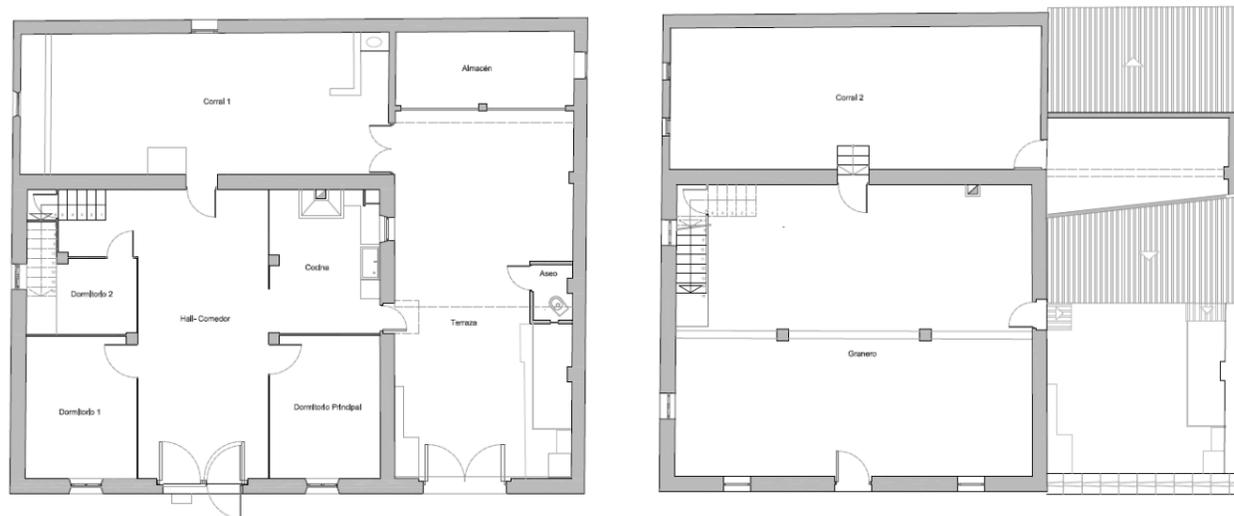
Cuarta Fase Alquería Visquet. Planta Baja y Planta Primera. Fuente: autor propio
